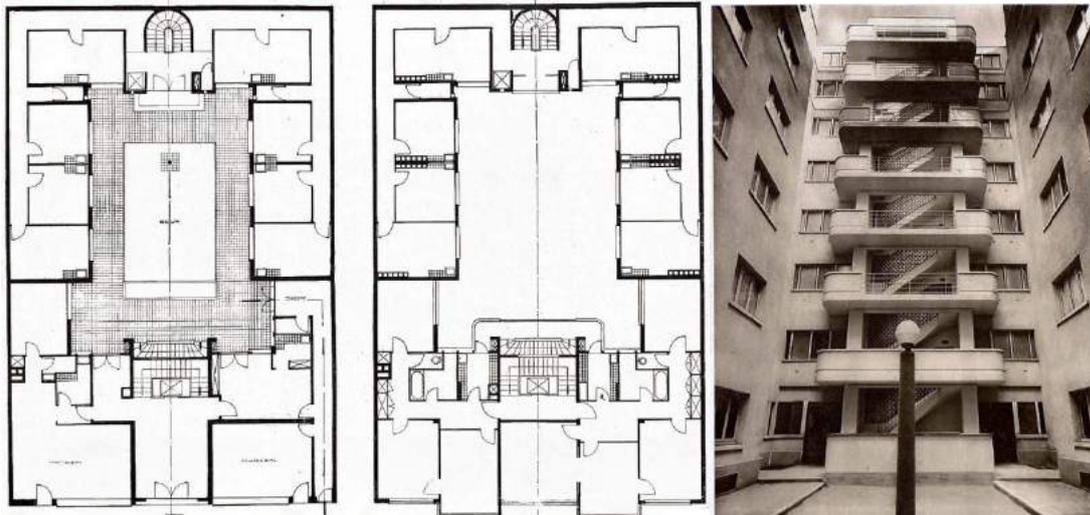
, Planta de acceso, planta tipo y patio interior del inmueble de apartamentos del arquitecto B. Elkouken, rue du Théâtre, Paris. Fuente: (Elkouken, 1931).
